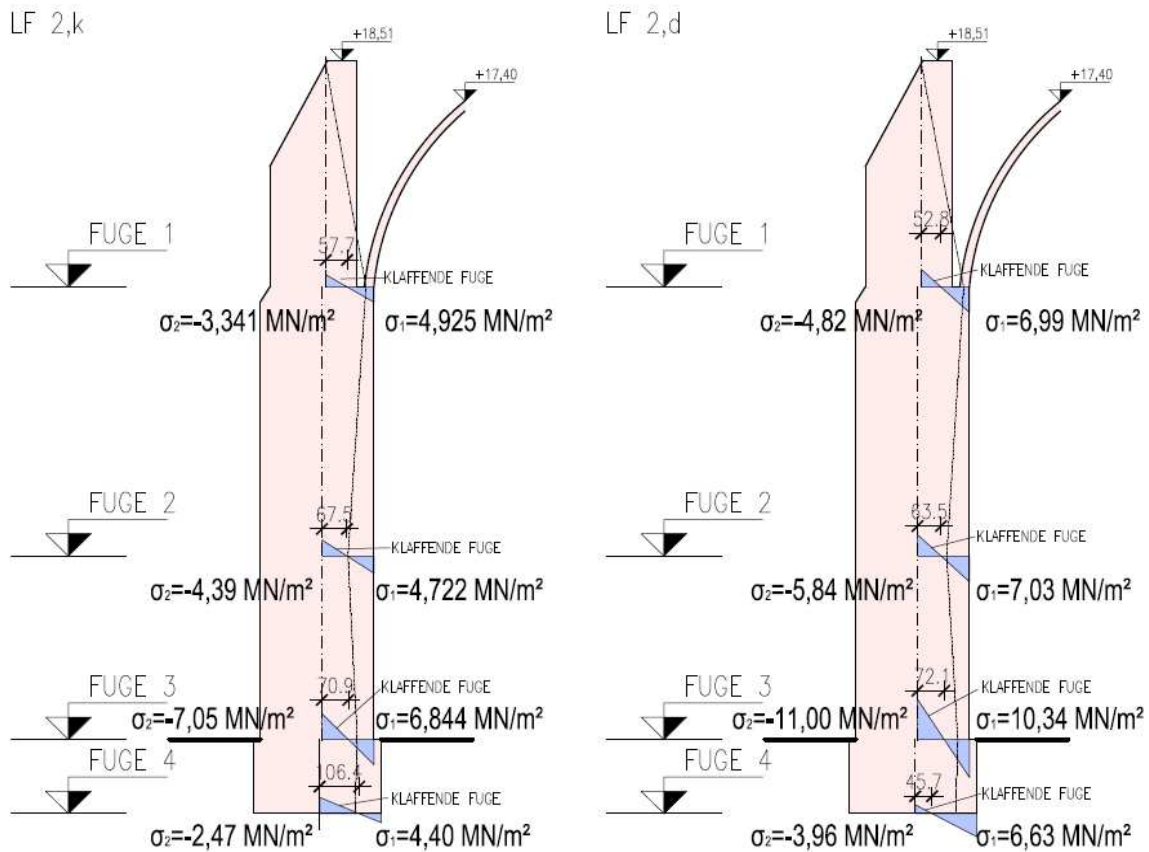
Strebeböfeler A5; Spannungsauswertung Lastfall 2, volle Windlasten aus dem Dachbereich und Eigenlasten
